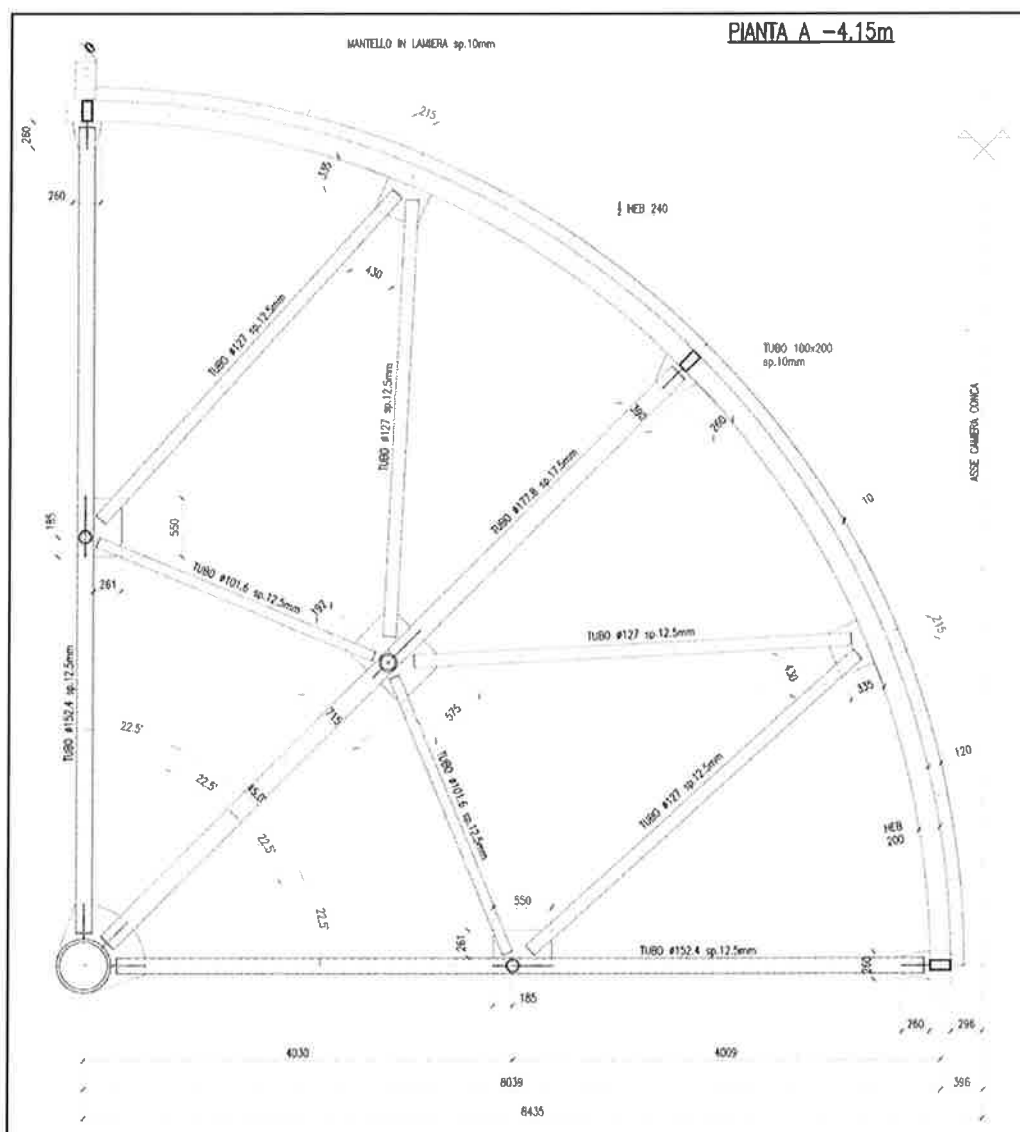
PIANTA TRALICCIO SPAZIALE PORTE CONCHE DI CHIOGGIA
